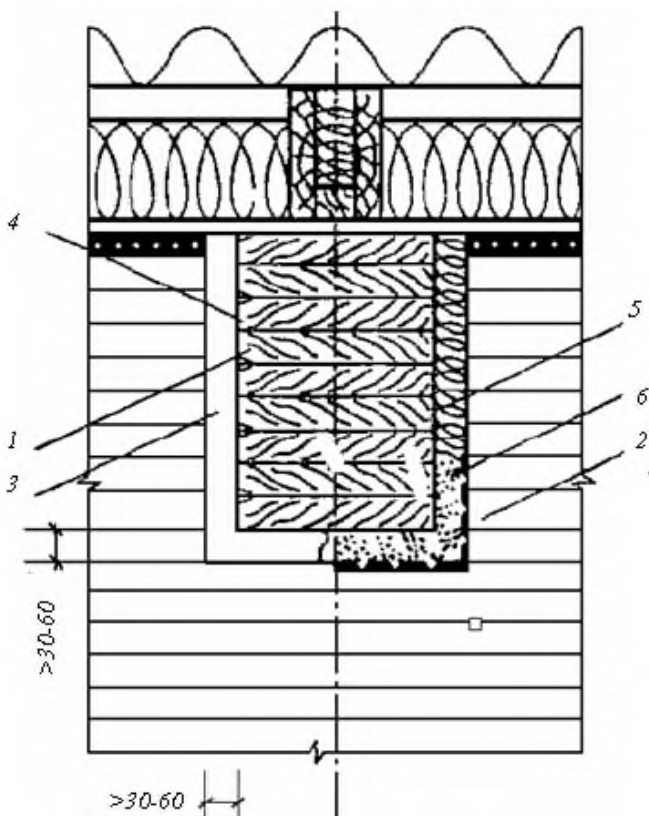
Огнезащита в местах пересечения несущей ДКК с каменной стеной или перегородкой: 1- несущая ДКК, 2- стена или перегородка, 3- воздушный зазор, 4- влагозащитная обработка или гидроизоляция; 5- минеральная вата, 6- нащельник.
